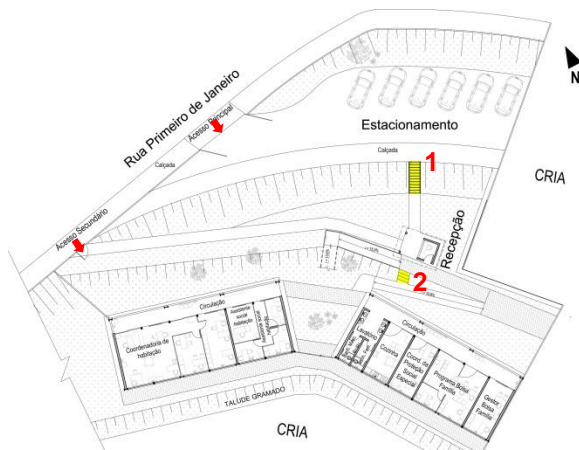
Planta baixa do 1º pavimento com escadas em destaque. Fonte: Adaptado pela autora com base em projeto cedido pela Secretaria de Obras
